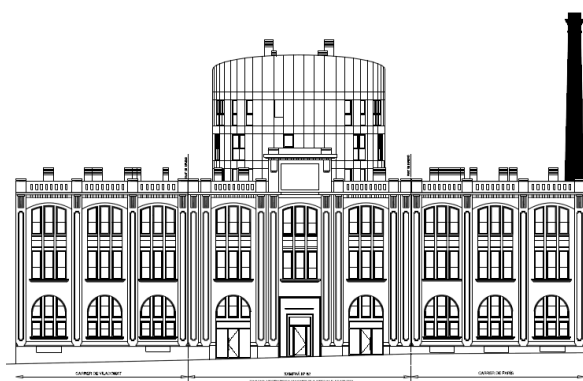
Plano de la actual fachada en donde se observa la sobreelevación de 3 plantas en un volumen circular retraído de las fachadas existentes (Fuente: García-Borés i Ruano Arquitectes, SLP).
